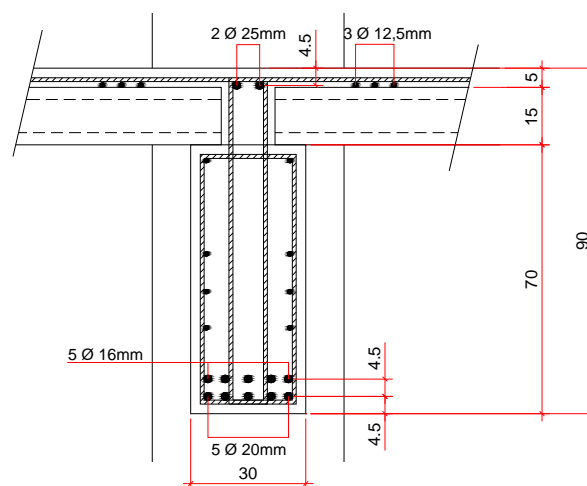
Seção transversal da viga de concreto pré-moldado em seção composta
